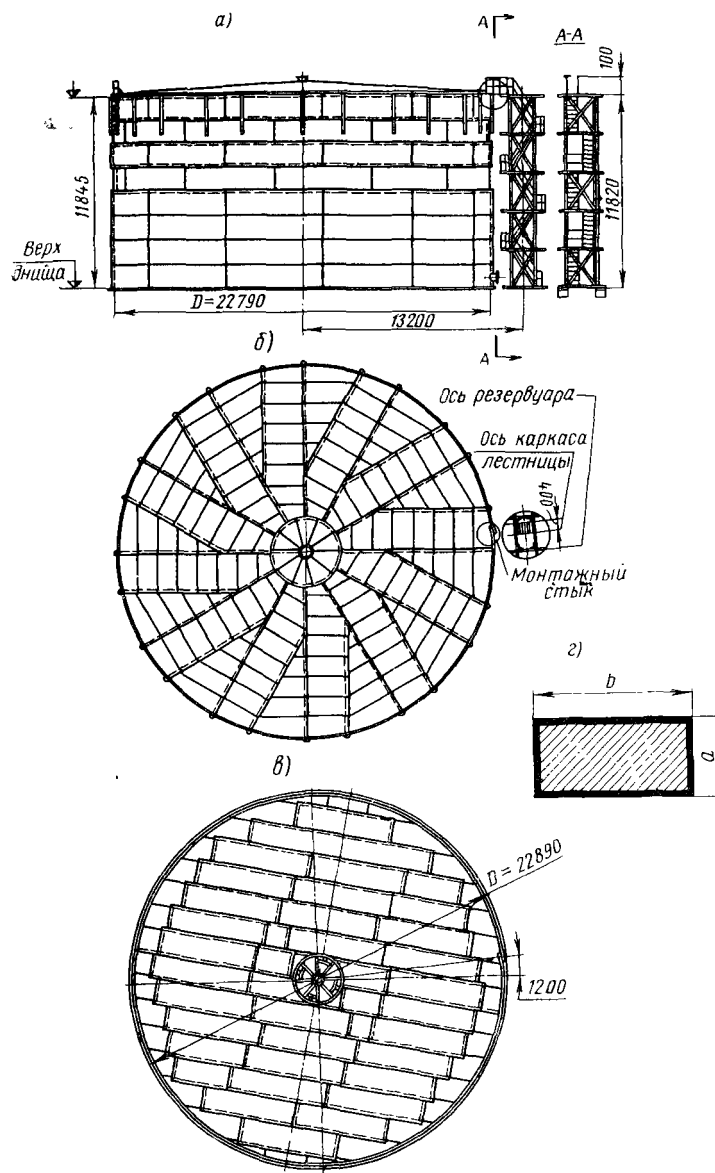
Общий вид резервуара емкостью $V=5000 \text{ м}^3$:
